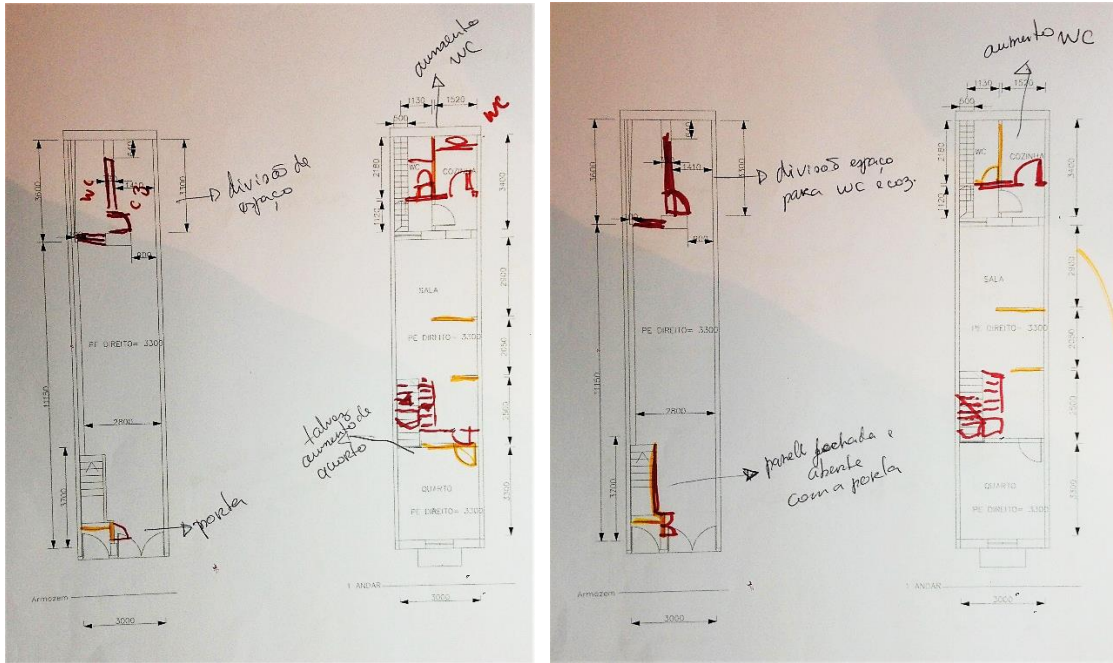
Desenhos estudos demolições e novas construção no armazem e primeiro andar.
